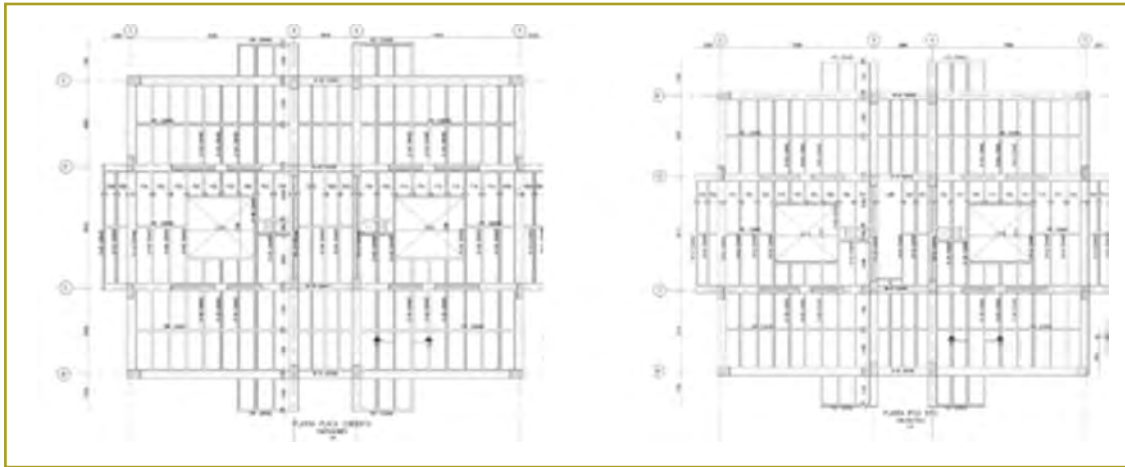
Plantas estructurales placa piso tipo y cubierta.
